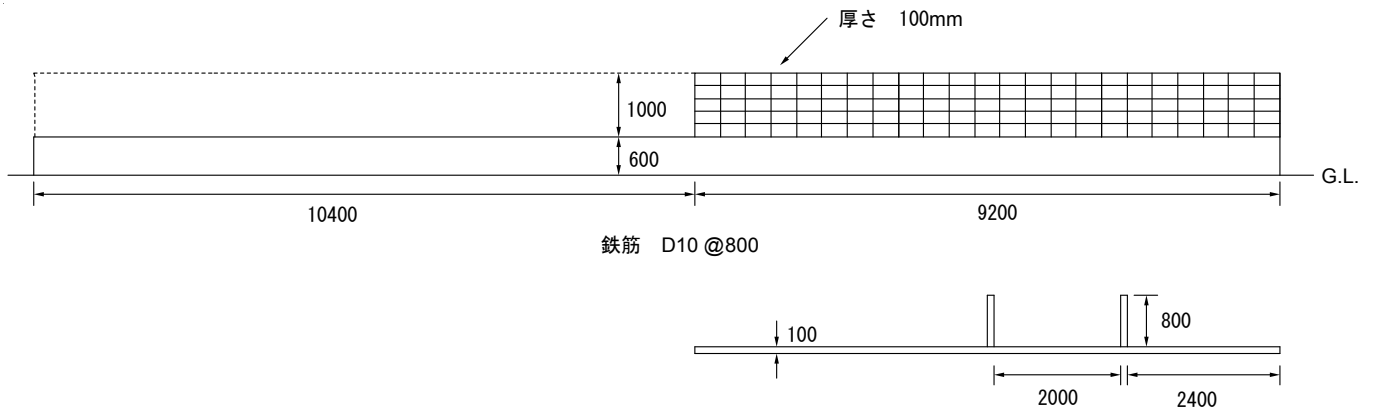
CB 塀立面・平面図 (単位: mm)
